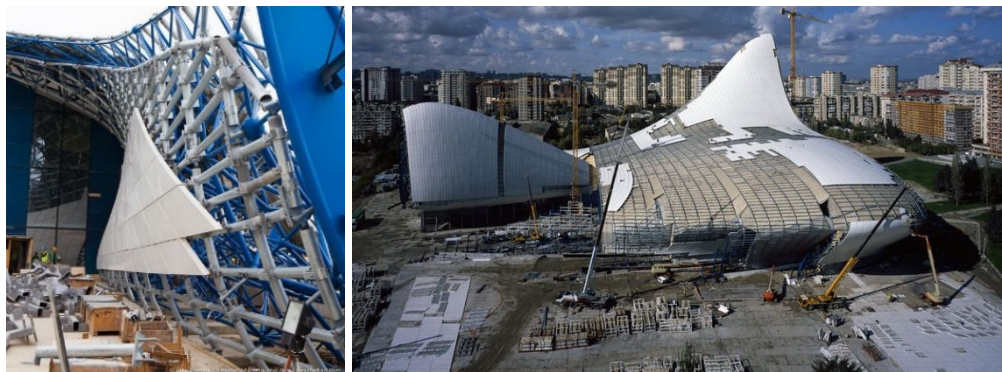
Camadas construtivas do Heydar Aliyev Center
